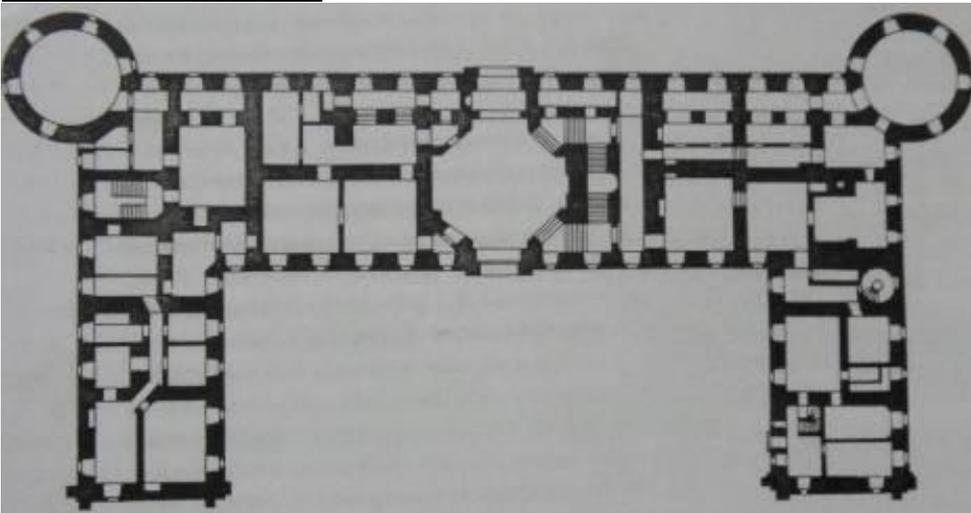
Schloss l'Huillier-Coburg in Edelény, Grundriss
